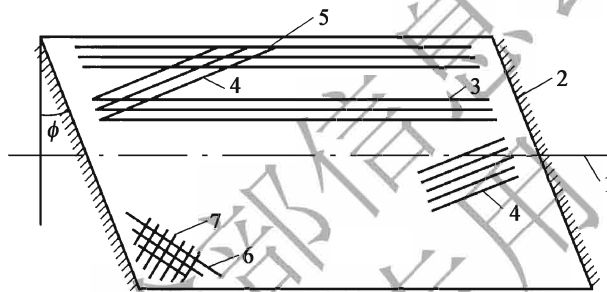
dispositions des armatures dans les dalles biaisées
